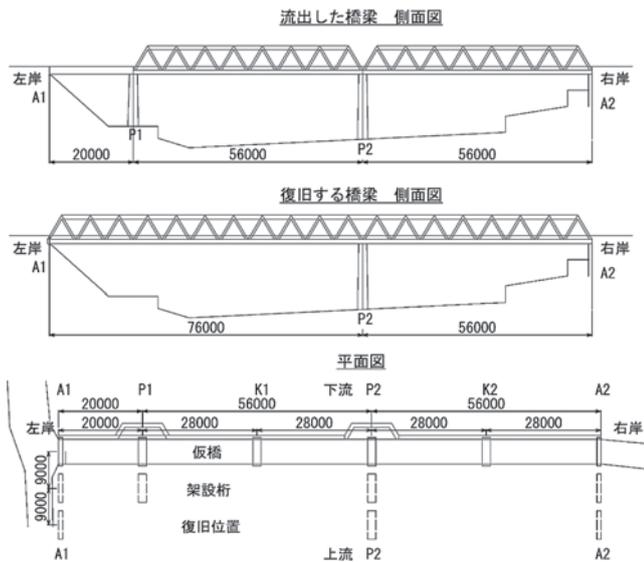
流失した橋梁と復旧する橋梁の側面図, 平面位置図
